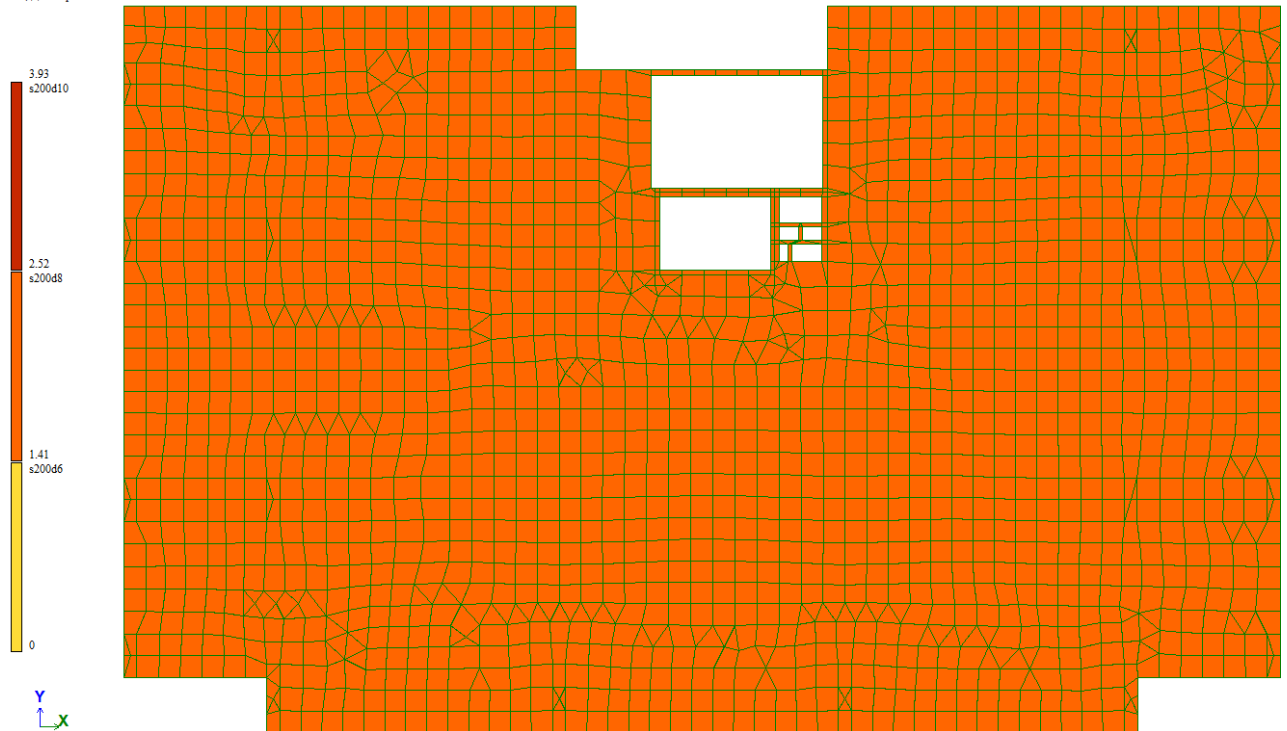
Нижнє армування плити першого поверху вздовж осі X
